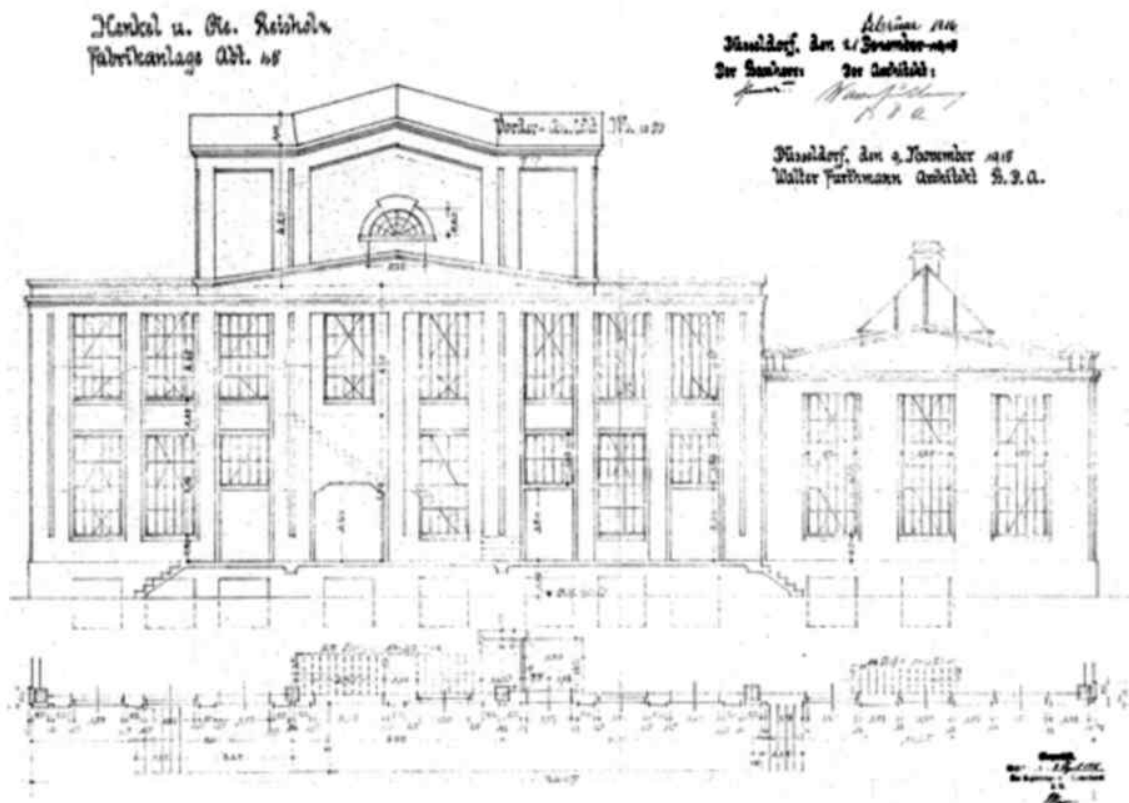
Errichtung Laugenfabrik Geb. F 05, 1917 - Architekt: Walter Furthmann
